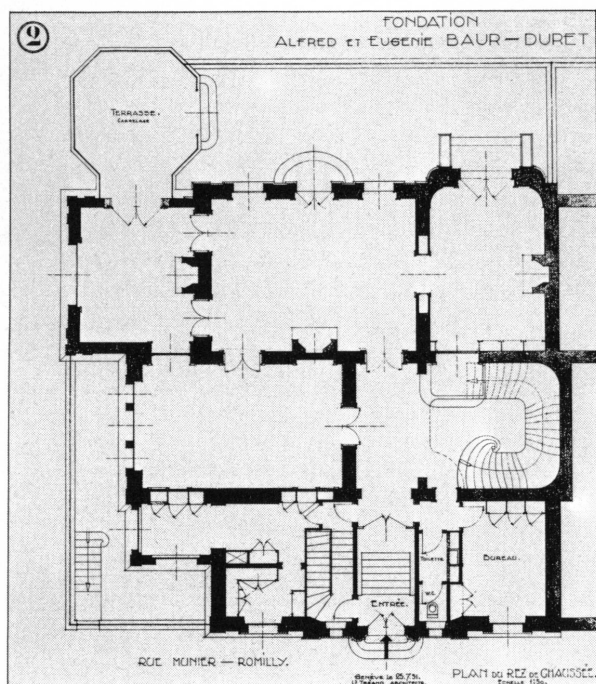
Rue Munier-Romilly n° 8. Plan du rez-de-chaussée.
